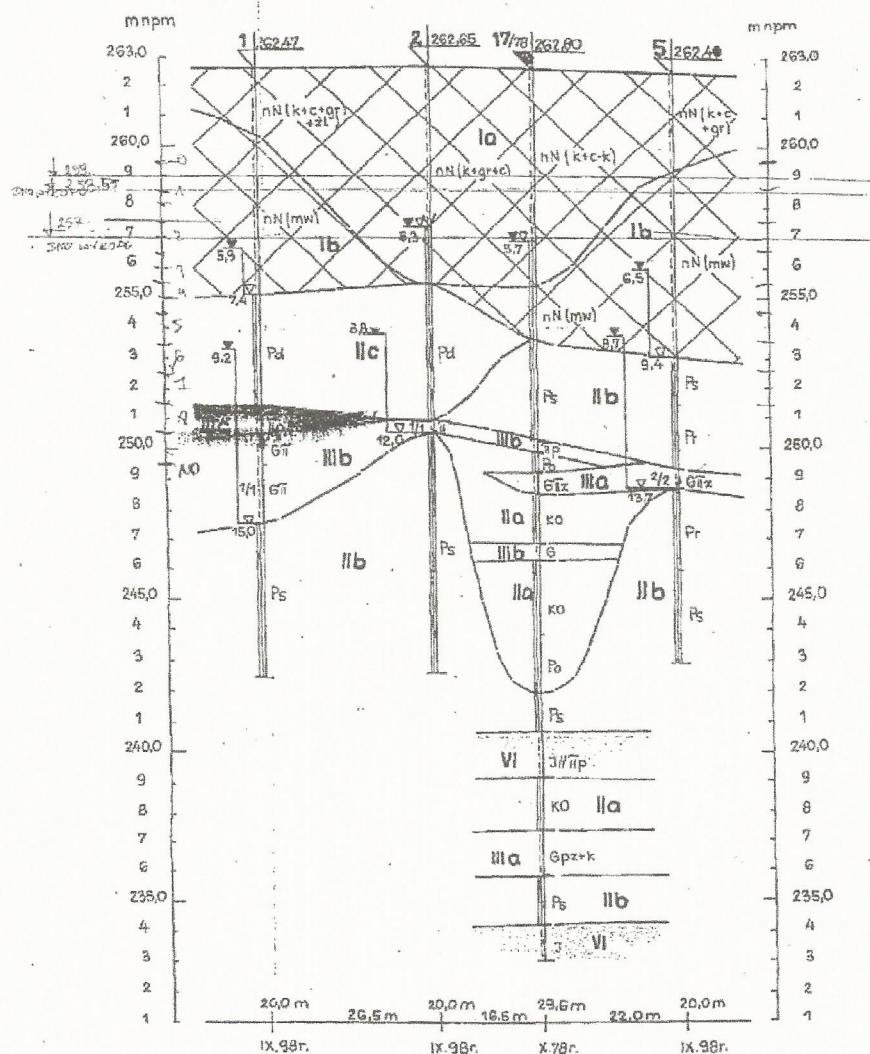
Przekroje geotechniczne II-II i III-III [1.3]
